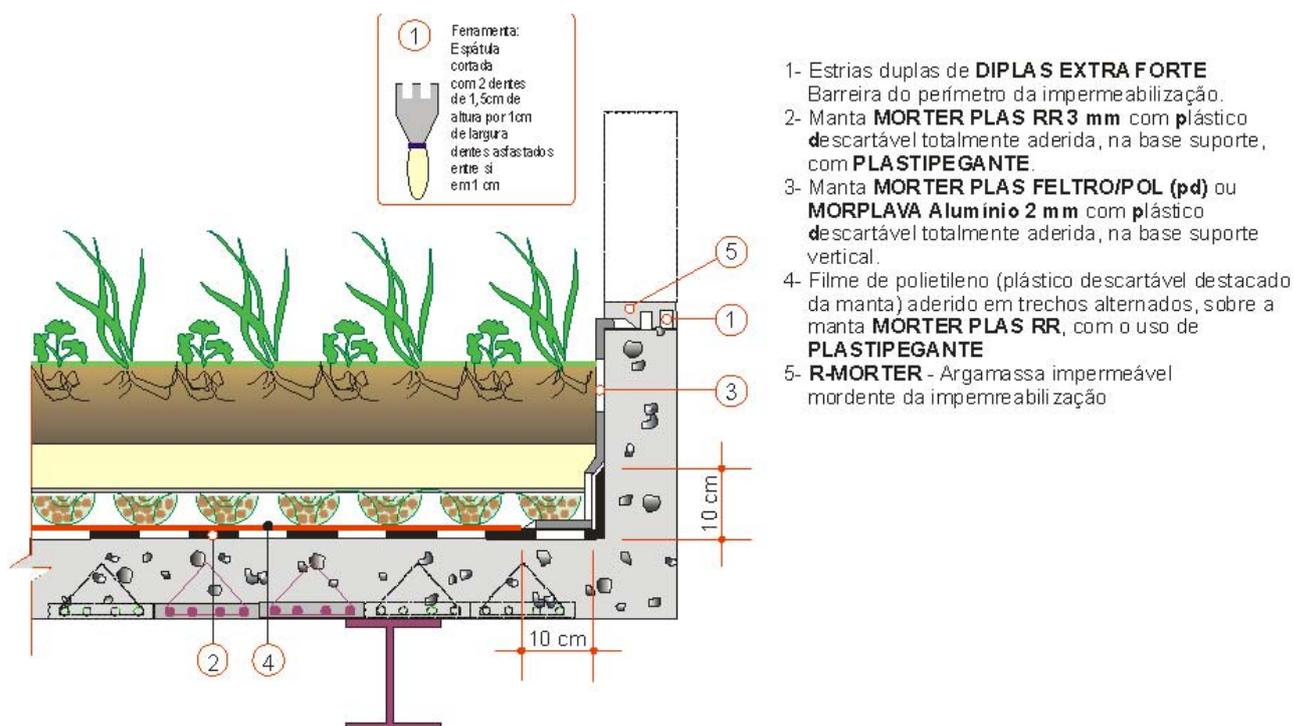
detalhe esquemático da especificação da impermeabilização das lajes verdes
